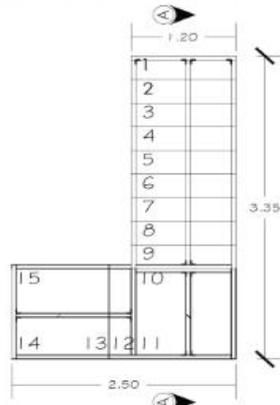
Planta estructura de escalera interiores (Tipología 3)-Esc:1/50
